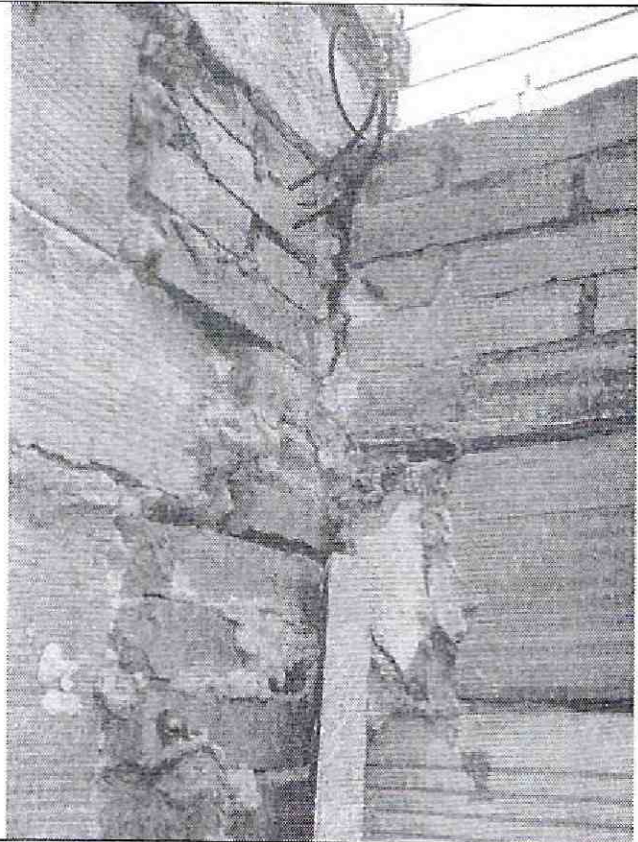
y 6. Aspecto general desde el interior zona patio. Muro de fachada segundo piso. Detalle daños fotos 7 a 9
